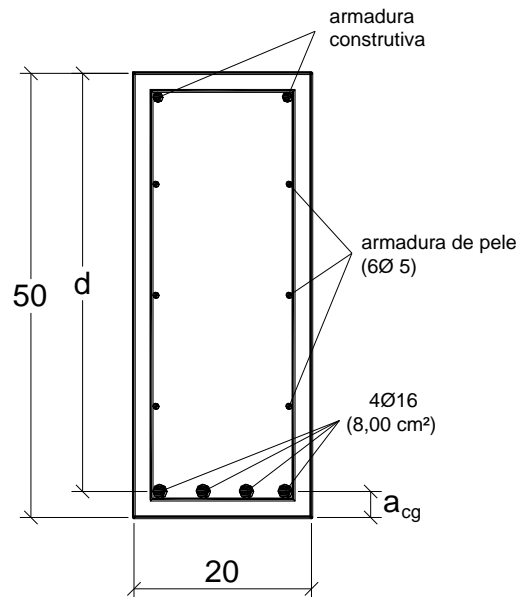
Detalhamento da armadura longitudinal A_s na seção transversal.
